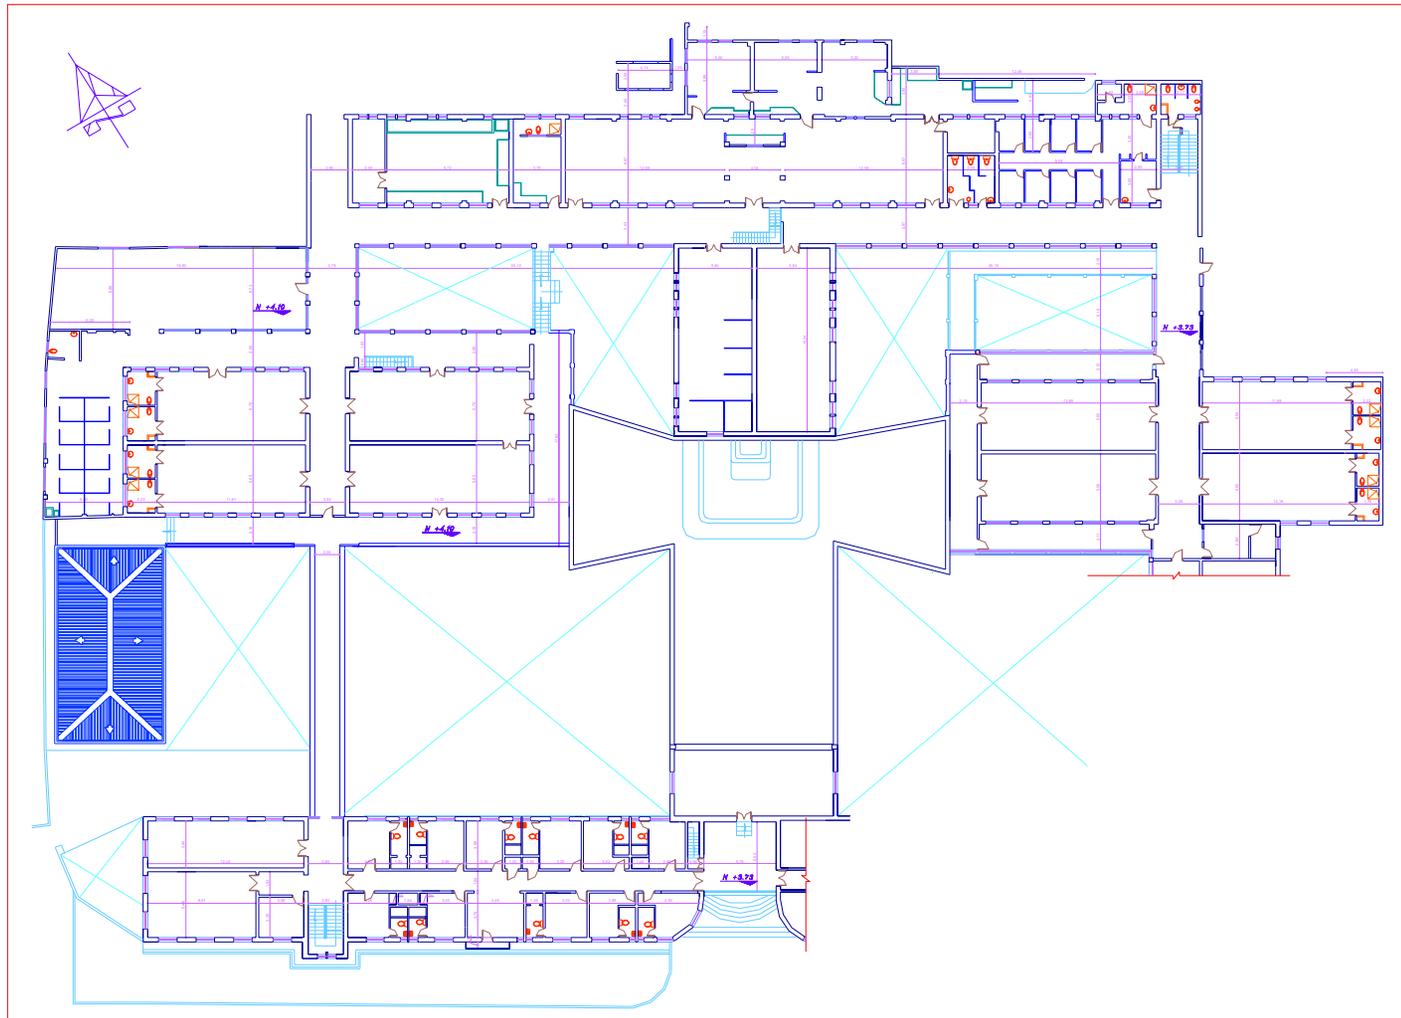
Planta Arquitectónica Segundo Nivel (AutoCad)
